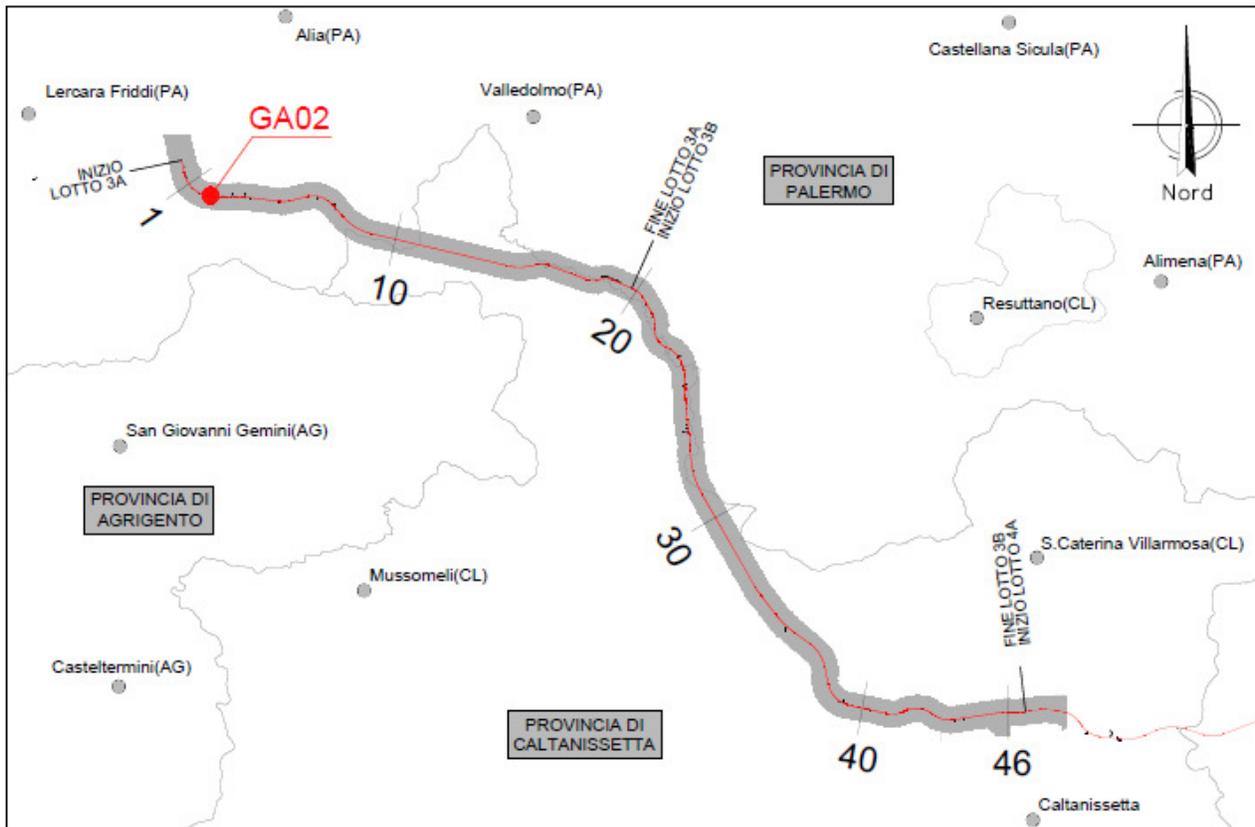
Inquadramento della GA02 all'interno del lotto di progettazione
